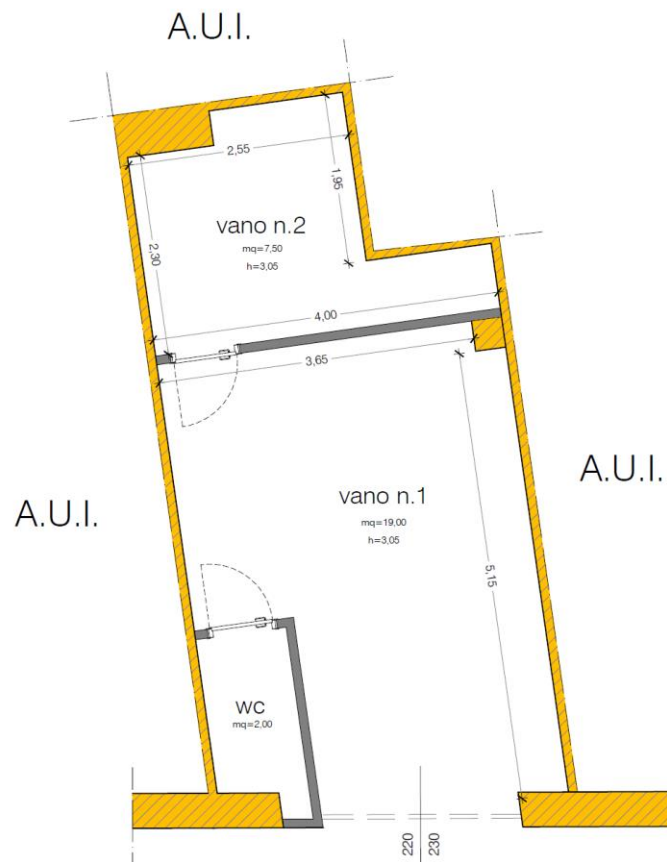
situazione planimetrica attuale (all'atto del sopralluogo)
